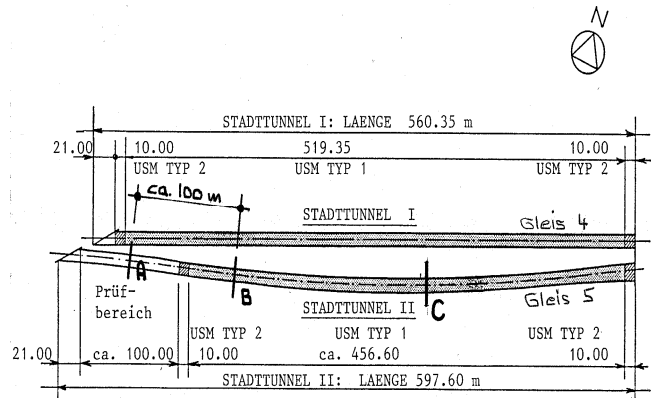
Situation Teststrecke Stadttunnel 2 Aarau
